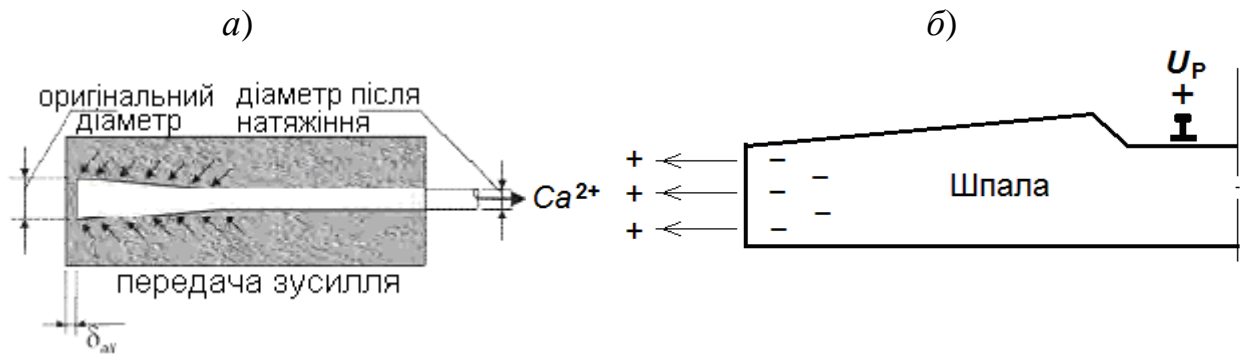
Схеми впливів, що сприяють утворенню тріщин в попередньо напружених залізобетонних шпалах: а – створення конуса розклинювання на довжині зони передачі напружень на бетон [132]; б – винесення катіонів Ca^{2+} з цементного каменю бетону шпали під впливом позитивного потенціалу на рейці
